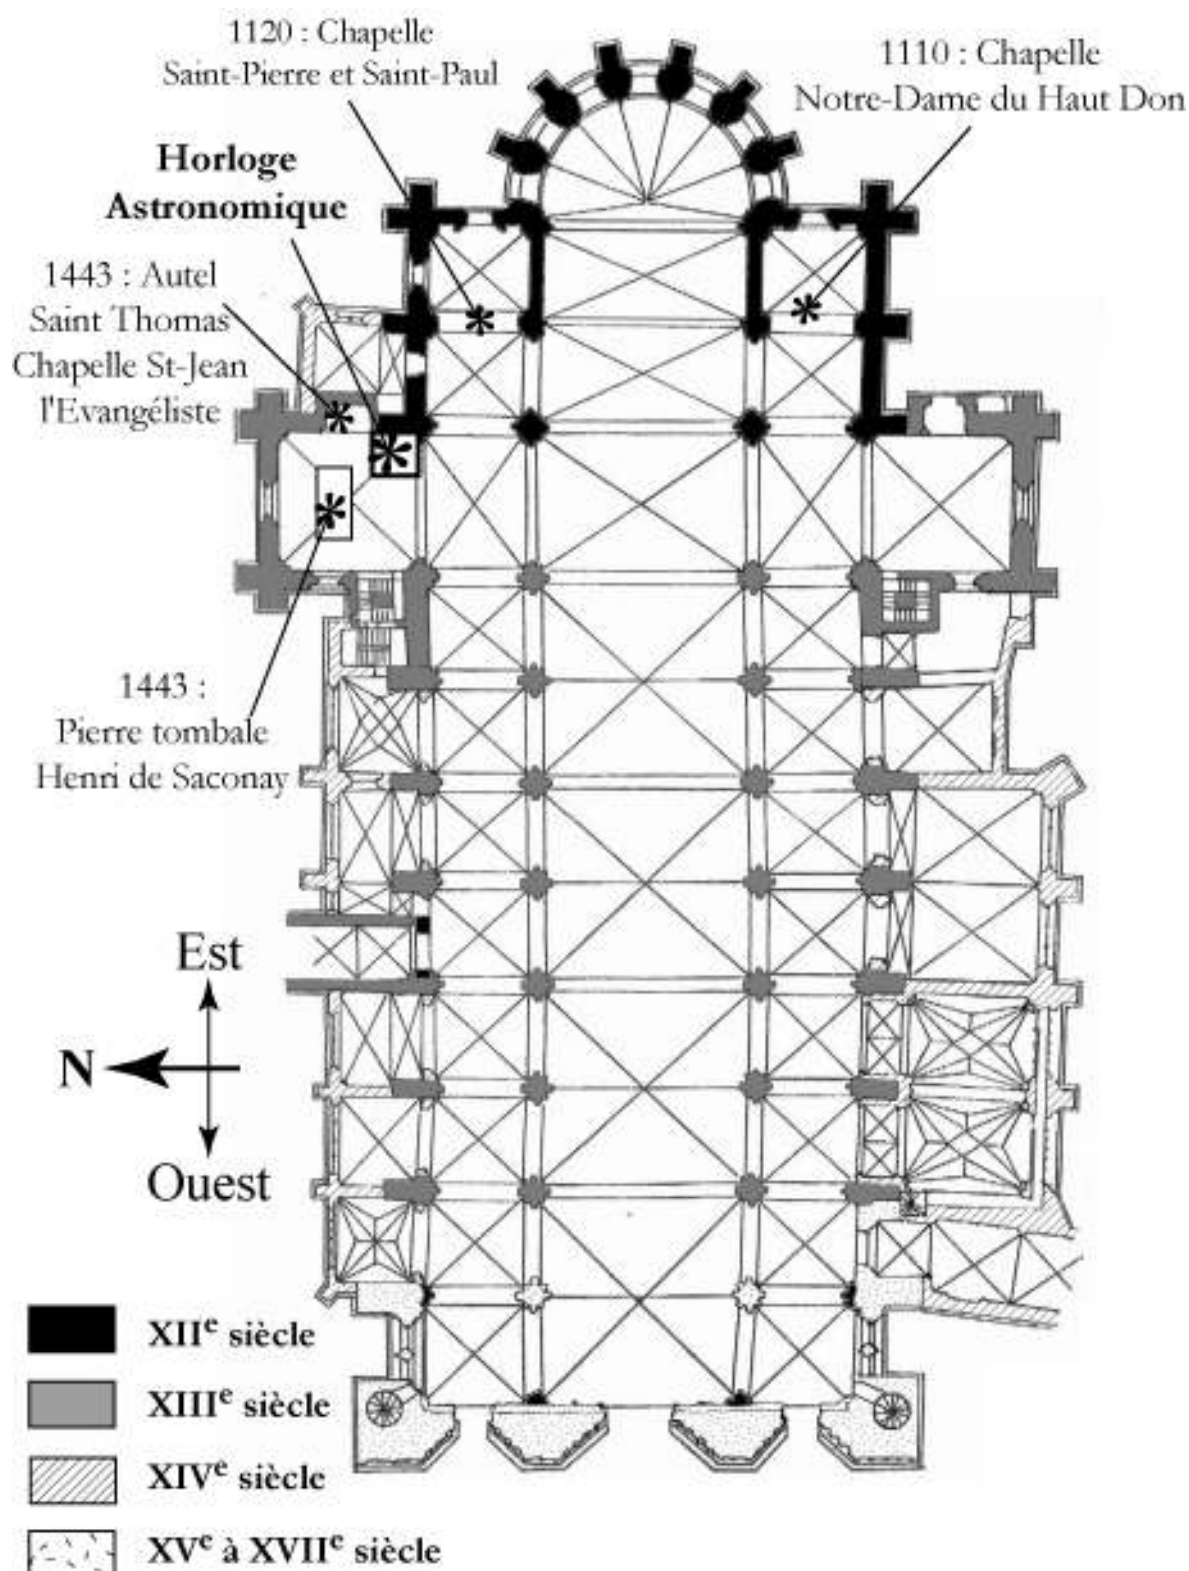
Plan de la cathédrale Saint-Jean de Lyon
